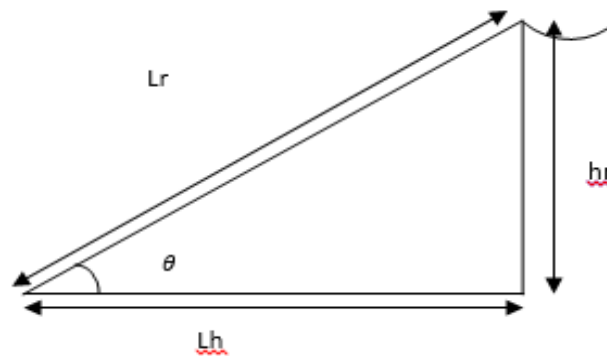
Vista en perfil de las rejillas. Fuente: Propia
